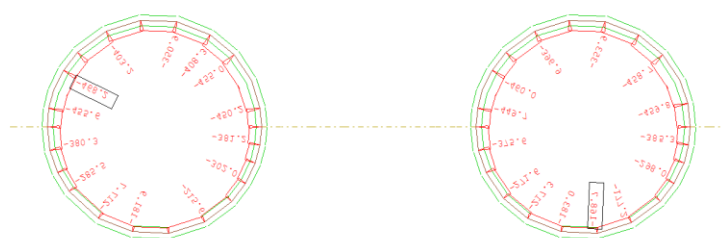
Эпюра продольных усилий, возникающая в конструкции железобетонной обделки на стадии завершеного строительства тоннеля в разрезе С-С
